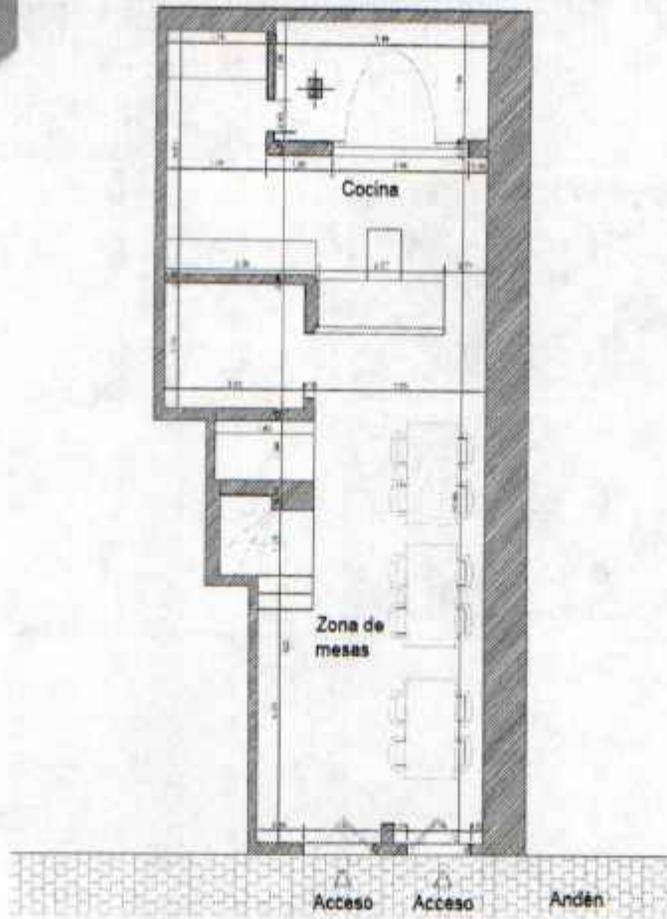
Plano JUAN DEL MAR PIZZERÍA – Área privada.
